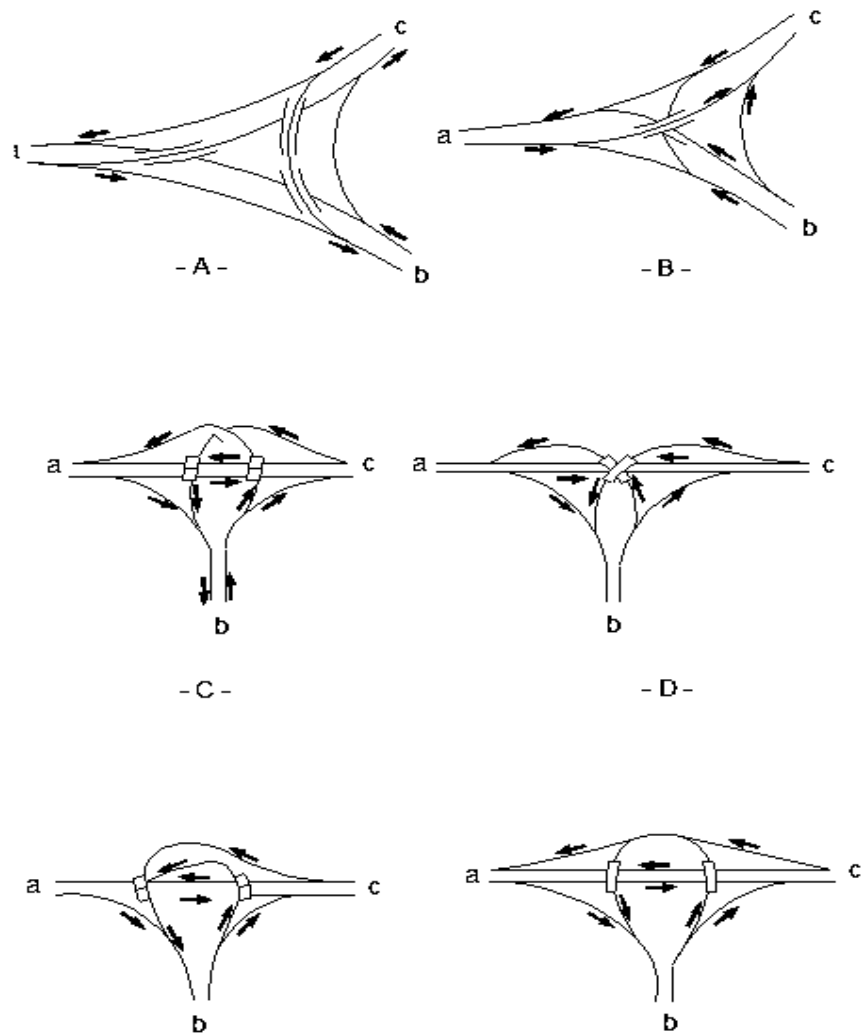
Intersecciones de tres ramas con estructuras múltiples (SCT, 2015)
